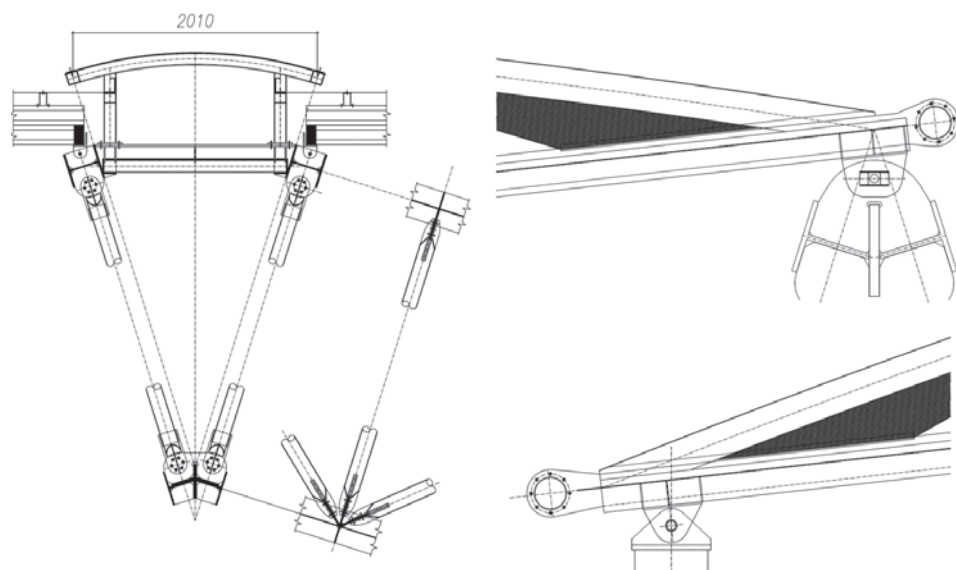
Sezione tipica della trave reticolare secondaria e dettagli di appoggio
